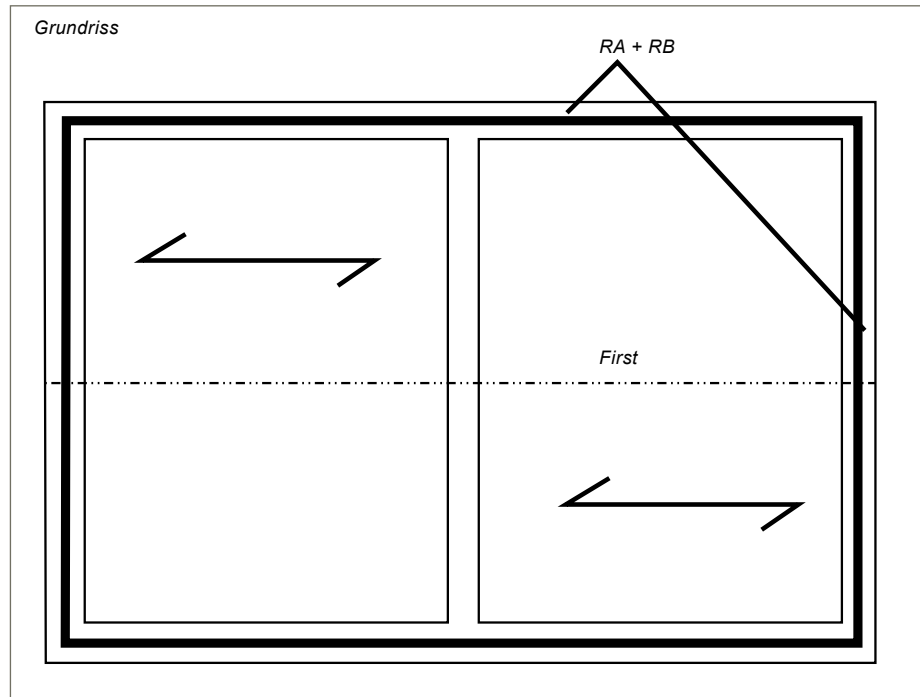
Verknüpfung von Ringanker und Ringbalken, Grundriss
